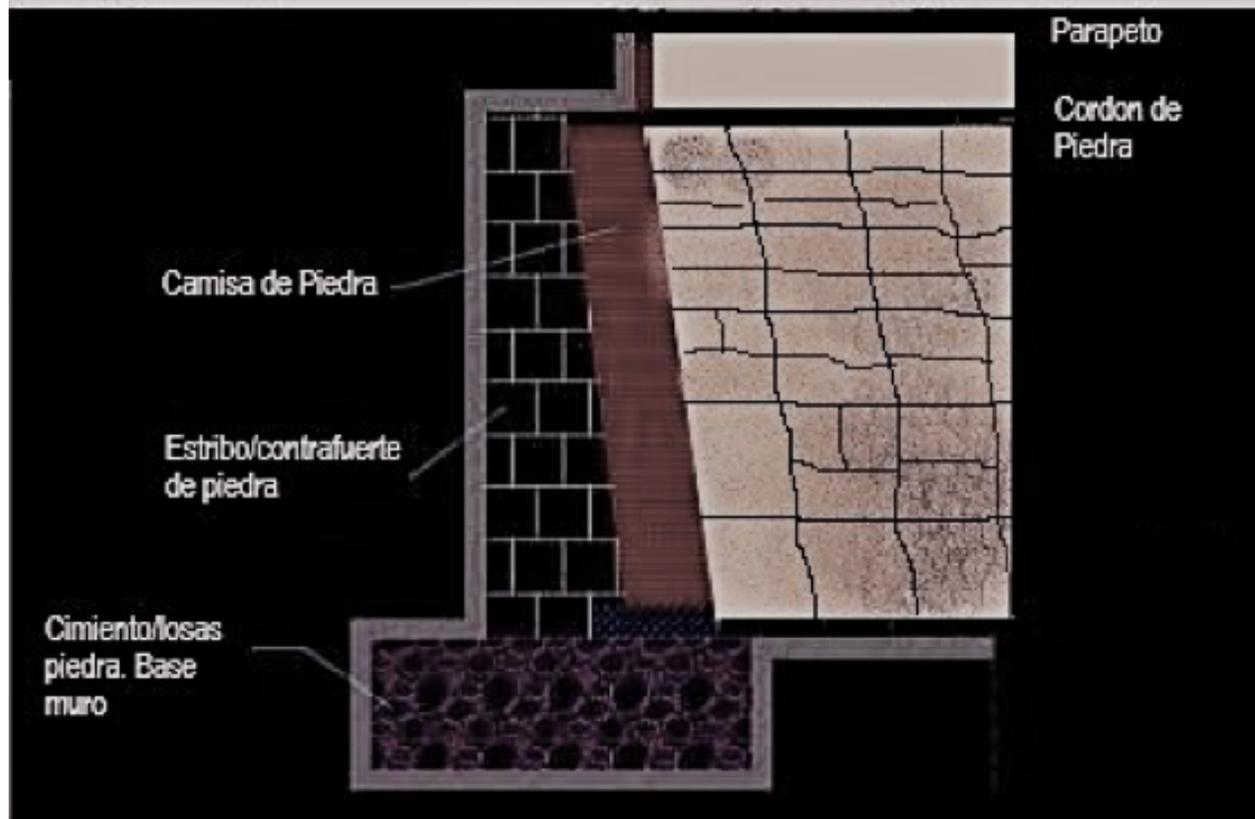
SECCIÓN TIPO DE UN MURO CON CONTRAFUERTE.
